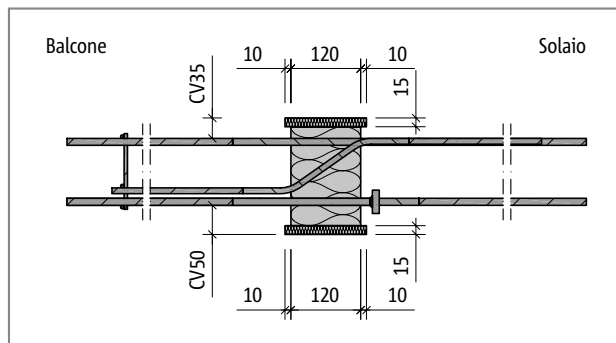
Schöck Isokorb® tipo EXT30-CV35, REI120: sezione dell'elemento
